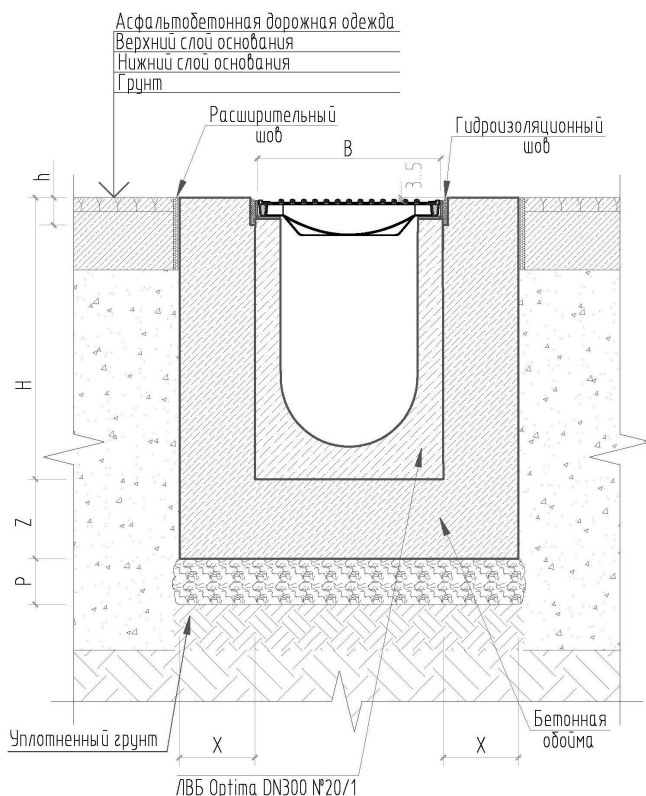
в – Устройство бетонной обоймы лотка с асфальтобетонным покрытием для классов нагрузки С250.
